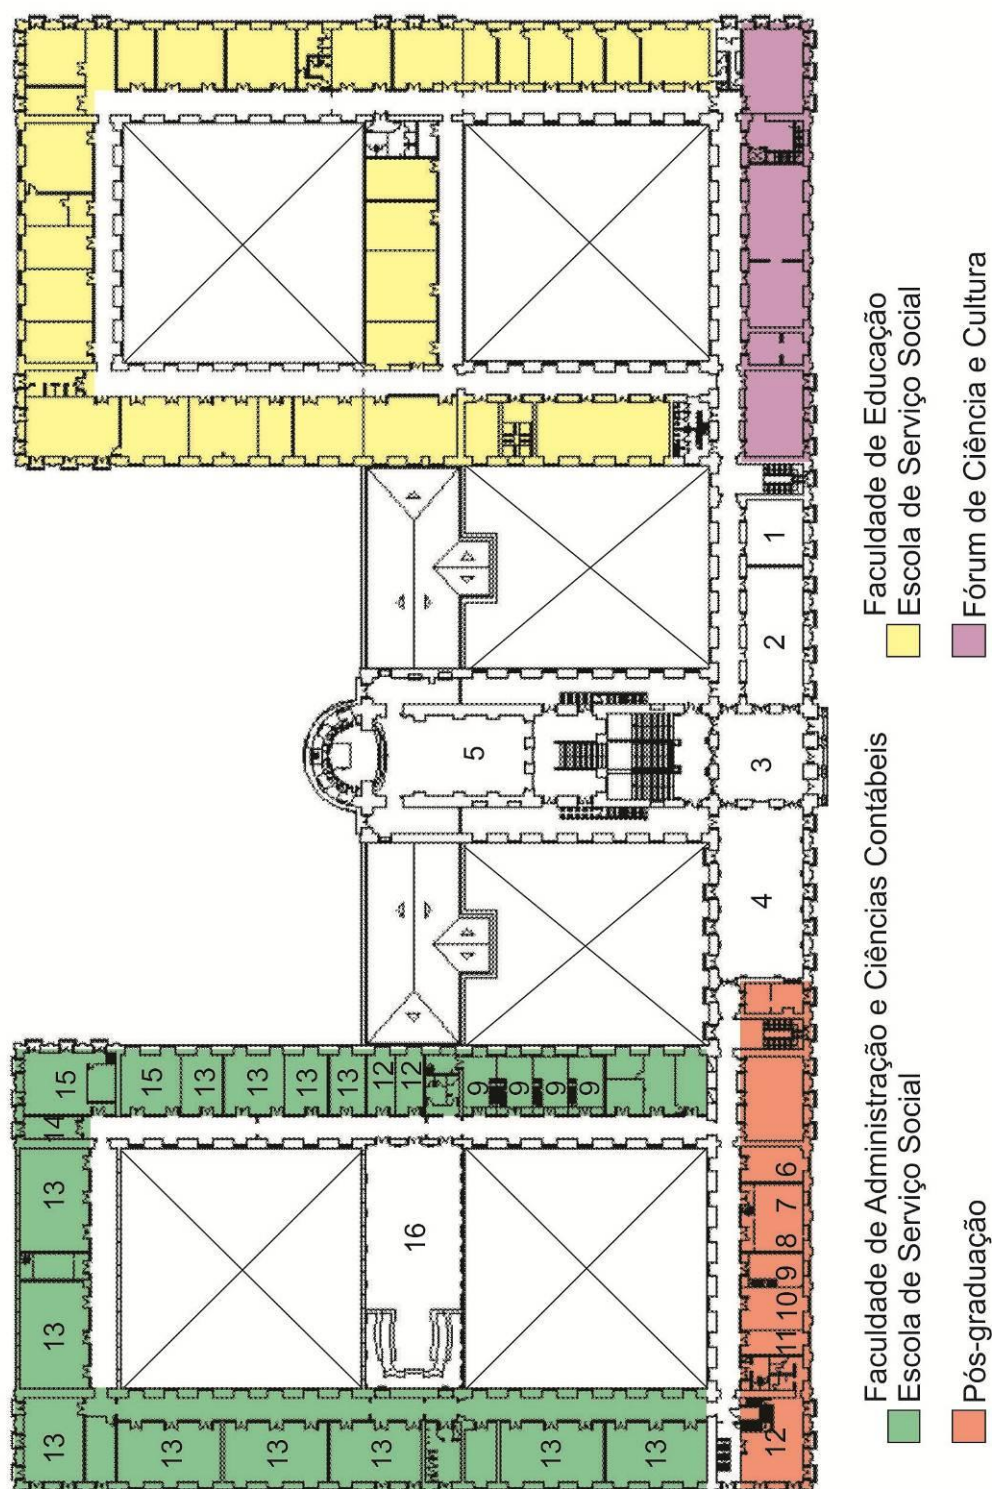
Planta do Primeiro Pavimento. Fonte: Hoirisch, 2007. Esquema da Autora.
